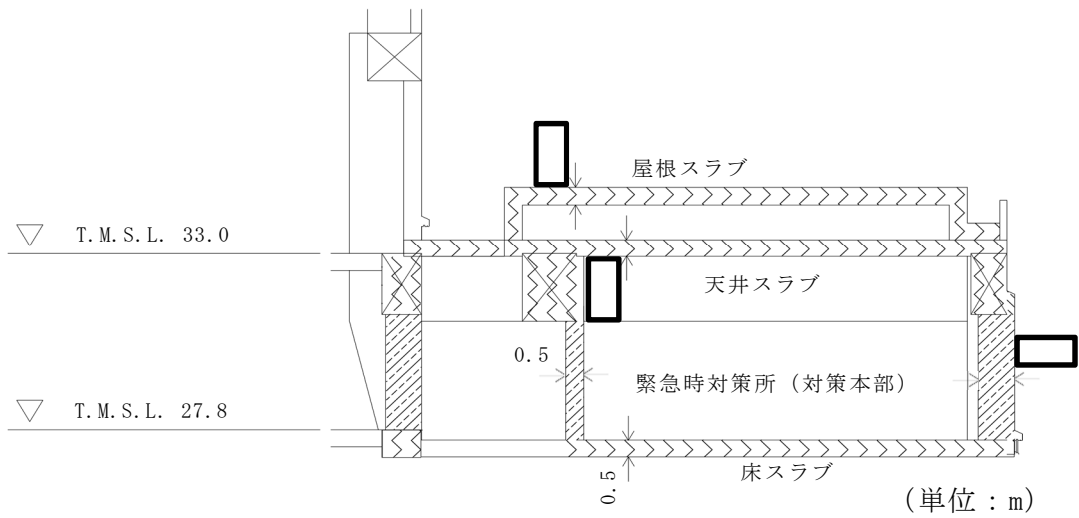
緊急時対策所遮蔽の概略平面図 (2/2)
